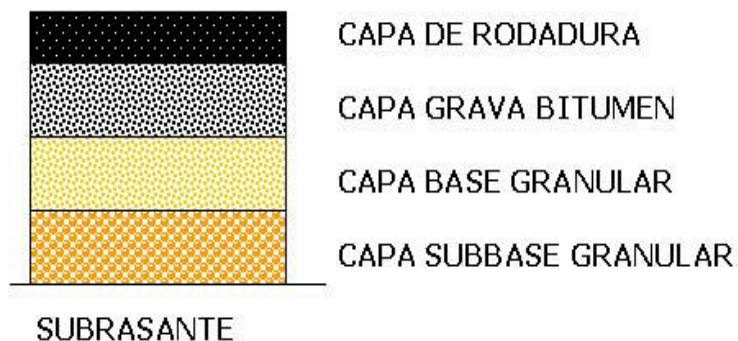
Sección típica de Estructuras de Pavimento Flexible.
